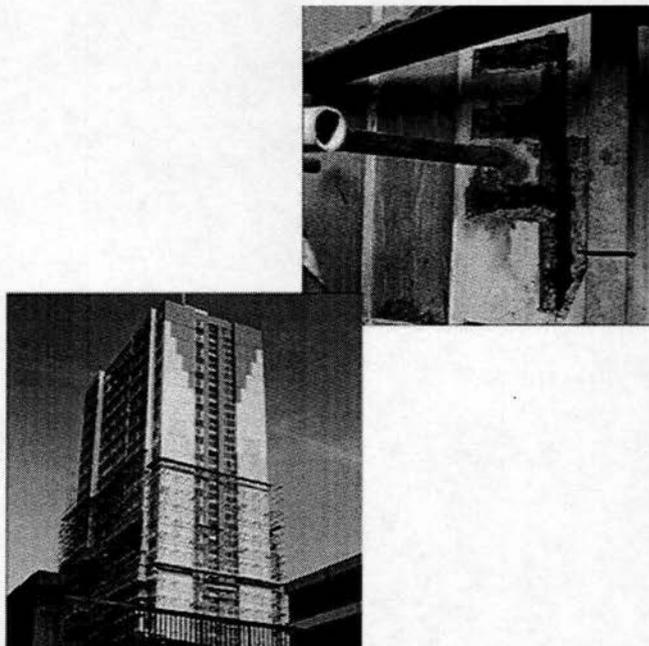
Edificio residencial de 26 pisos de altura con estructura en concreto aligerado.
